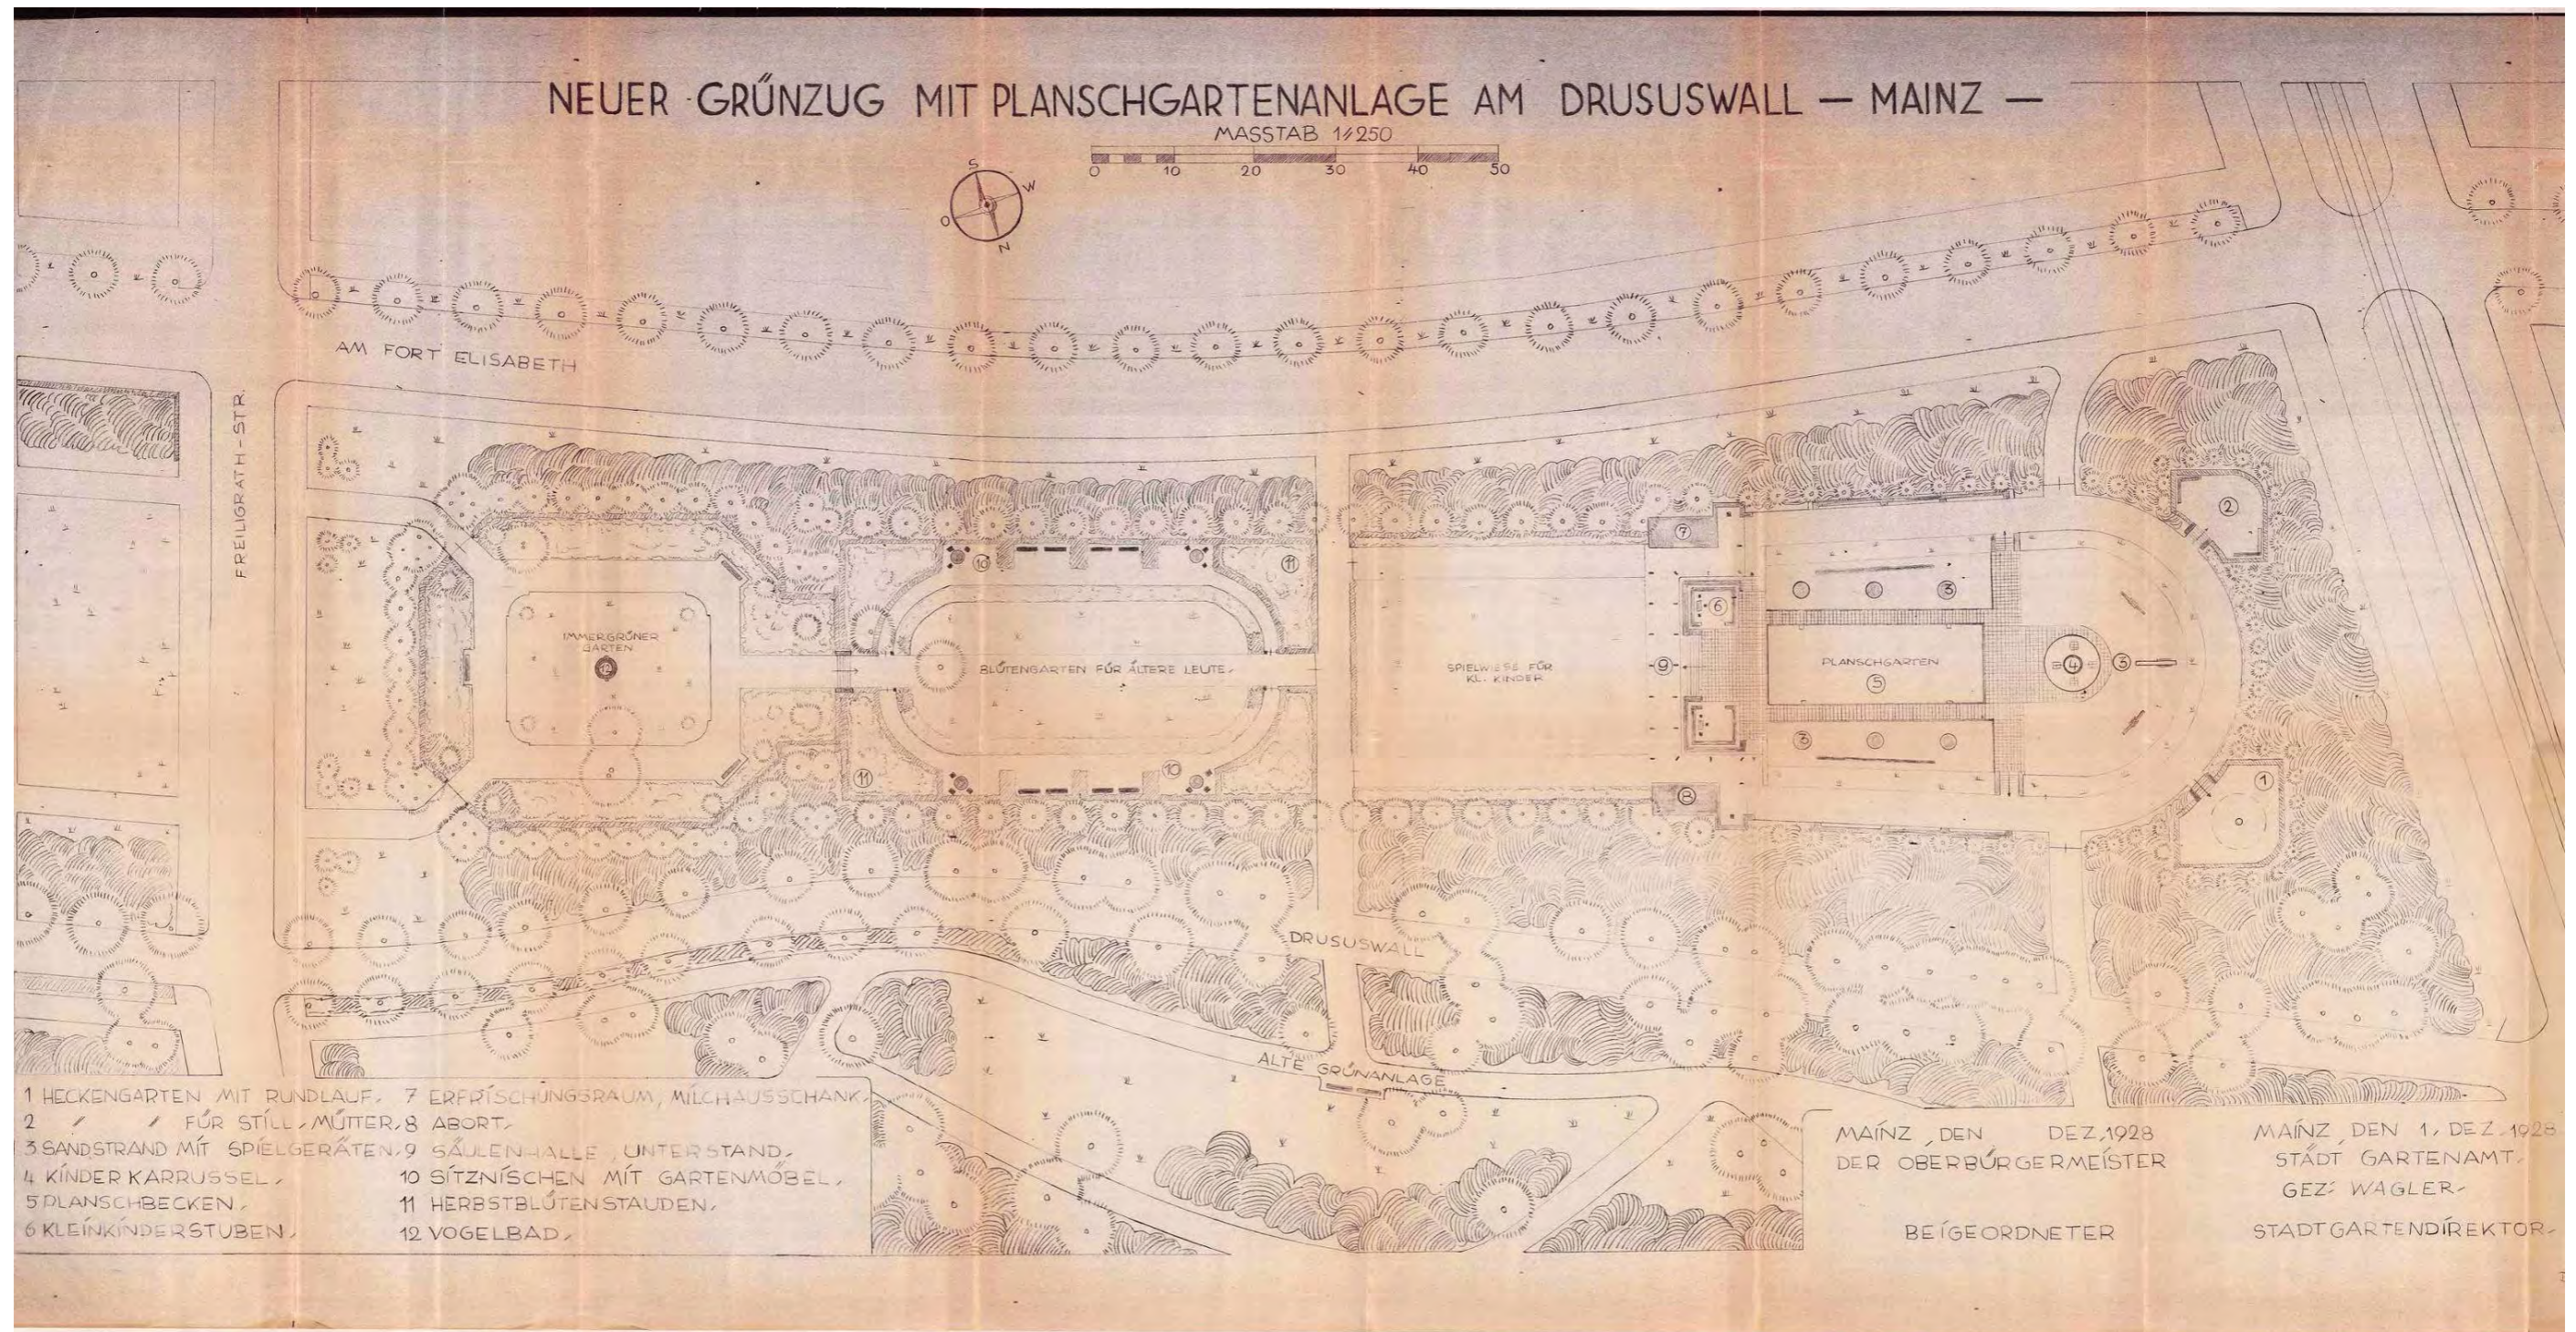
Neuer Grünzug mit Planschgartenanlage am Drususwall, Dez. 1928
